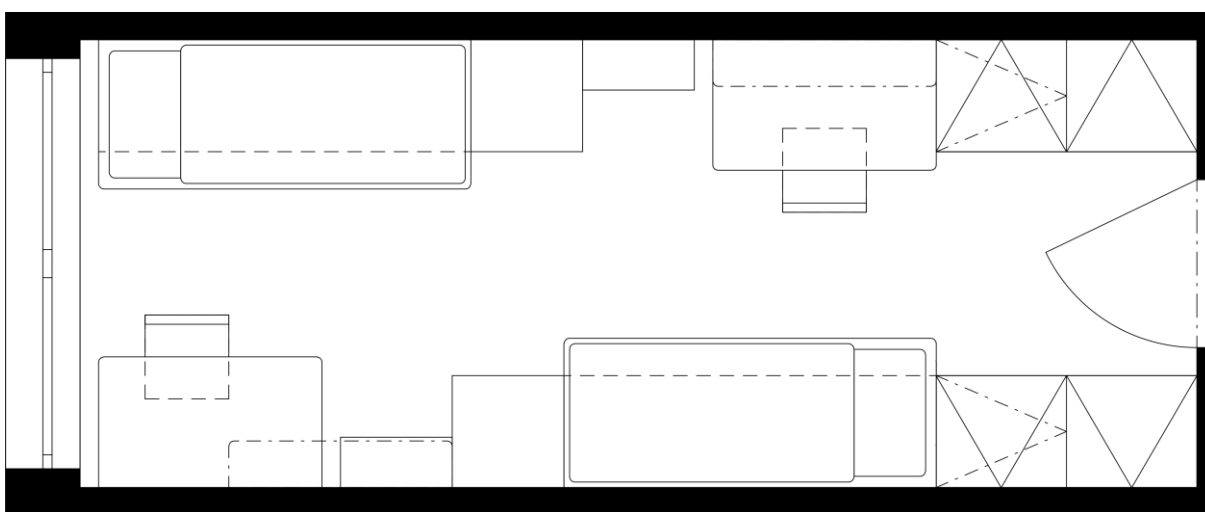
Půdorys základní dispozice pokoje kolejí Strahov, 2023
